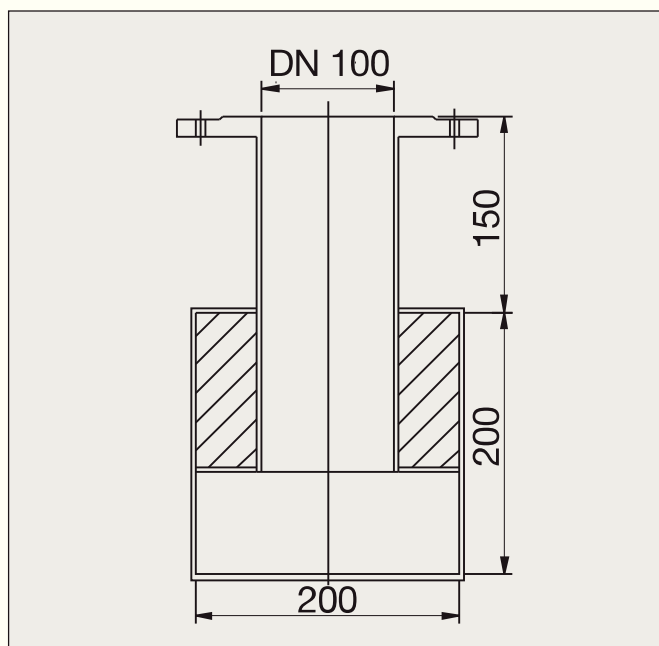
Hrdla přírub v jedné rovině, standardní délky 150mm
